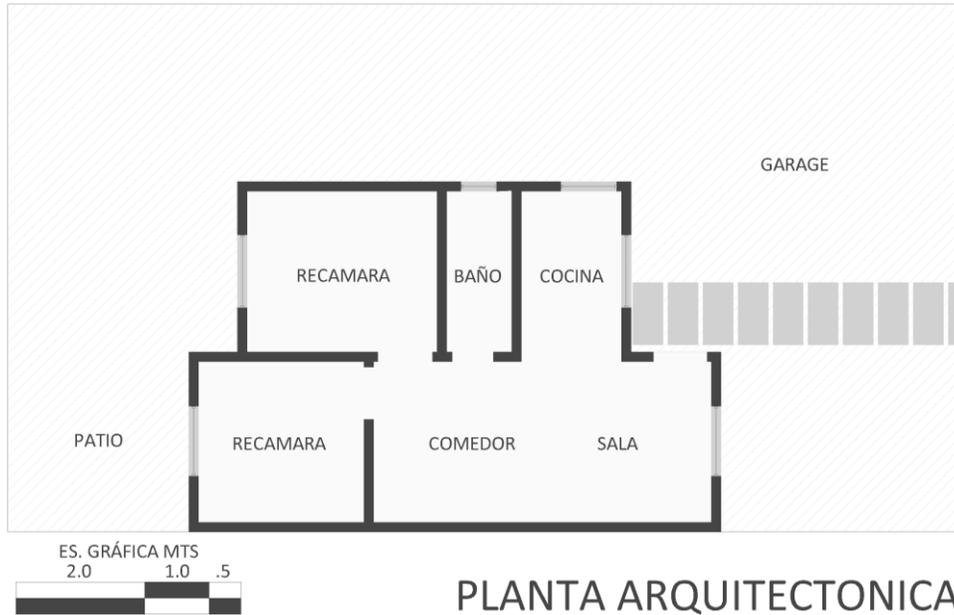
Planta Arquitectónica Fraccionamiento Dunas. Fuente: Dibujo propio en base al proyecto del Fraccionamiento.
